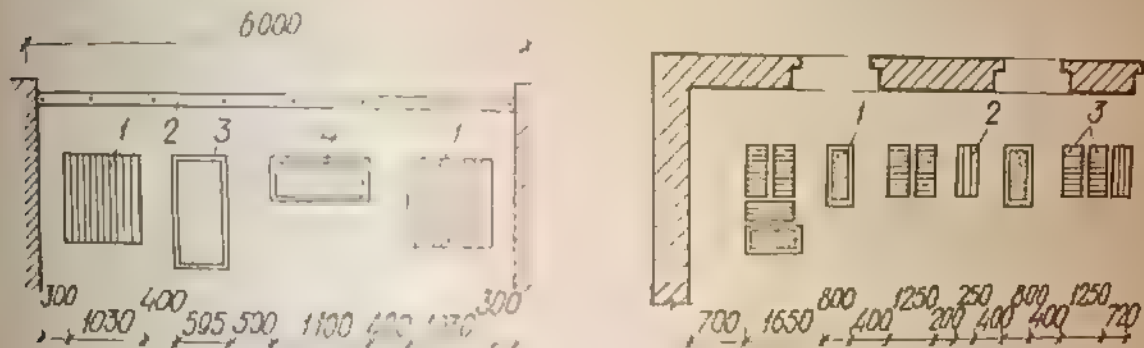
Организация рабочего места при кладке перегородок из гипсобетонных плит
